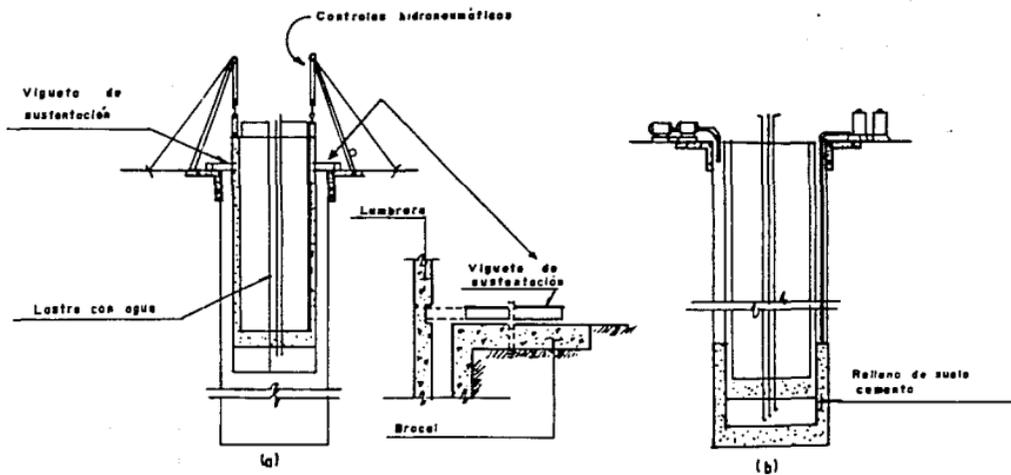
DESCENSO DEL TANQUE HASTA SU POSICION FINAL
